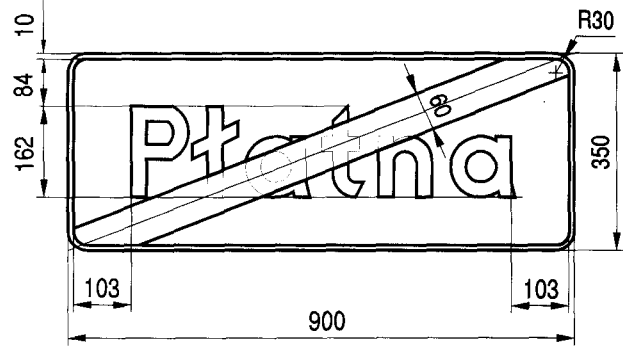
Konstrukcja tabliczki T-25b
